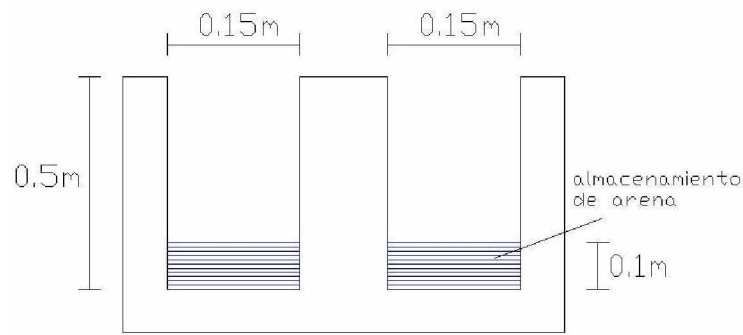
Sección transversal del desarenador para la Planta N°2
